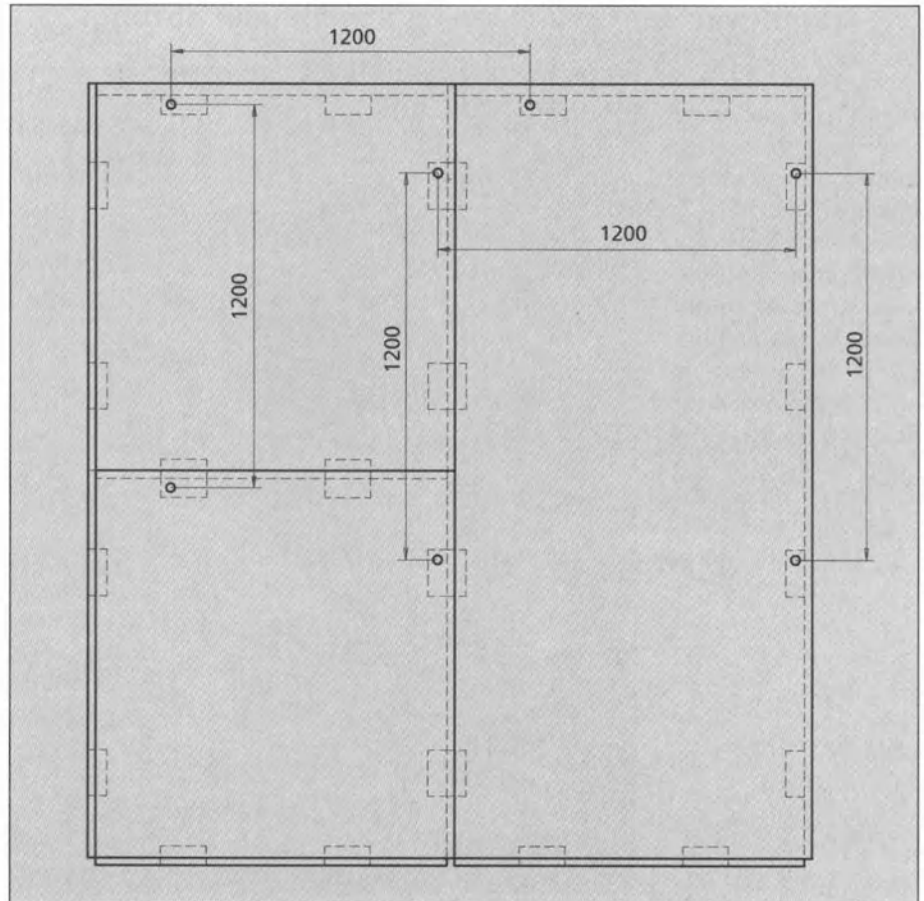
Схема укладки подвесных резьбовых стержней М8
